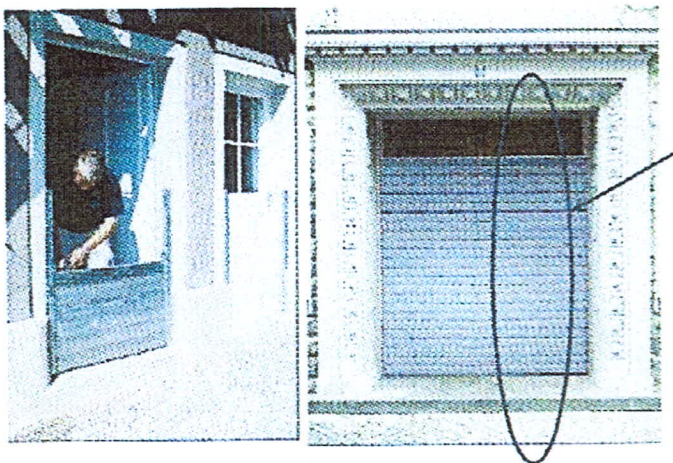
อุปกรณ์ป้องกันน้ำ Flood Barriers
